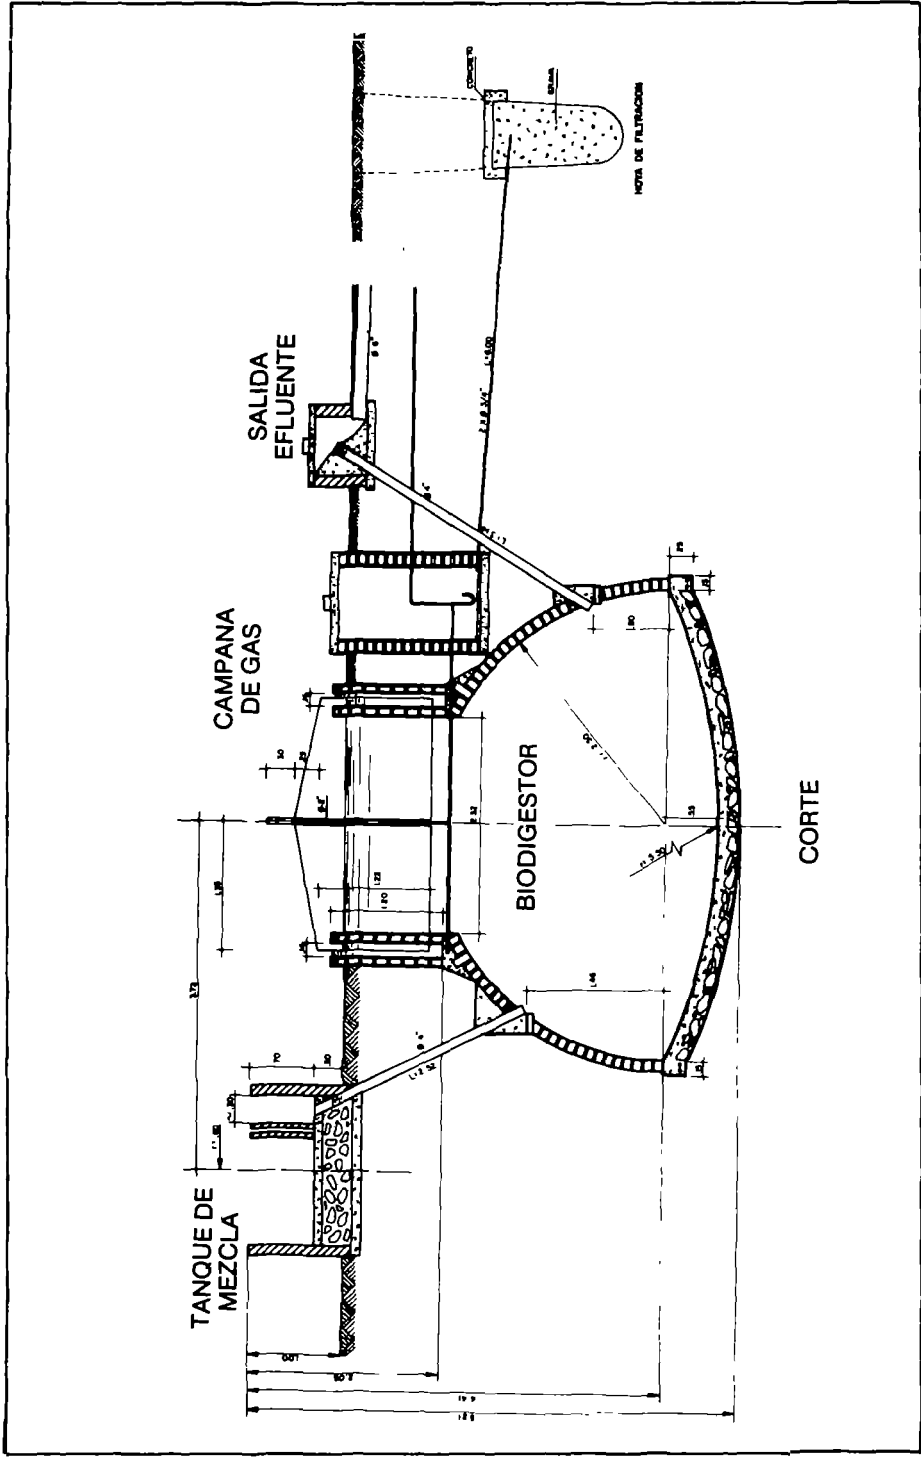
Primera Planta de biogás construida por el proyecto, para FUNDAEC, La Arrobleda - Caloto (Cauca)
